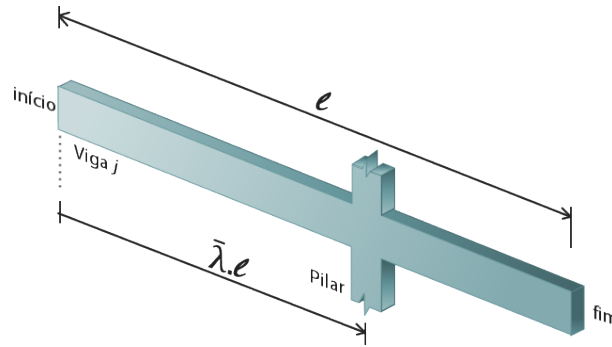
Parâmetro de um pilar em uma viga do pavimento.
